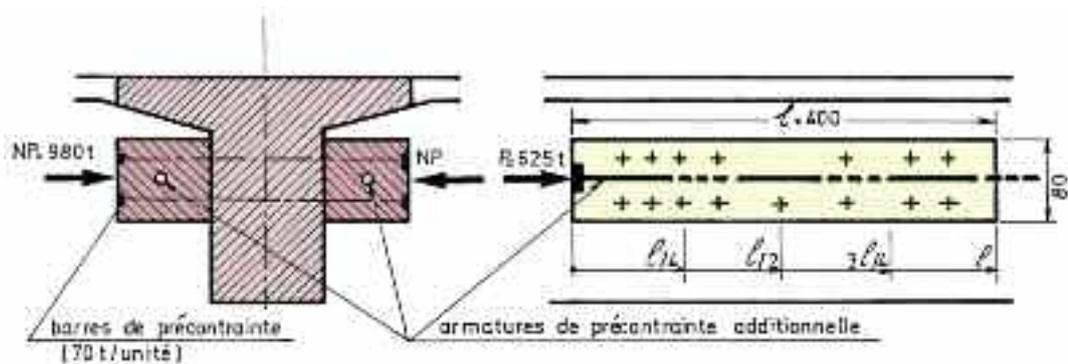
schéma des bossages d'ancrage du pont de Lestelle
